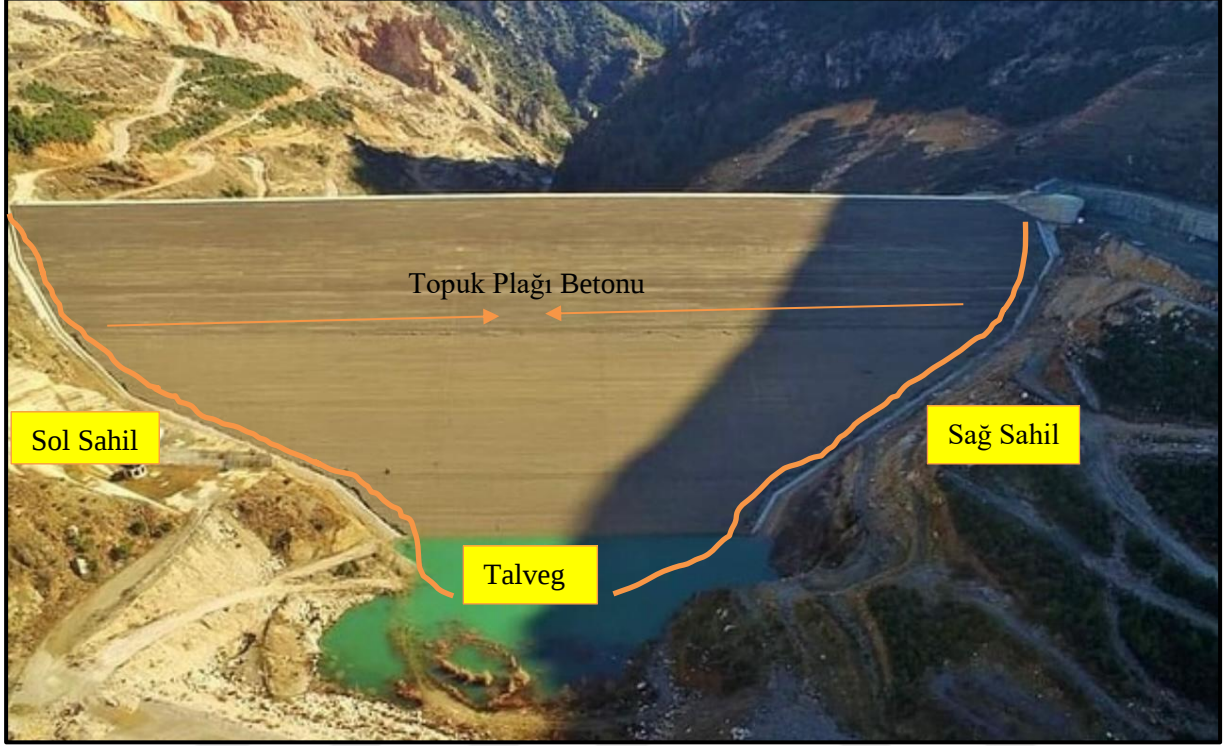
Pamukluk Barajı topuk plağı betonu dökümü
